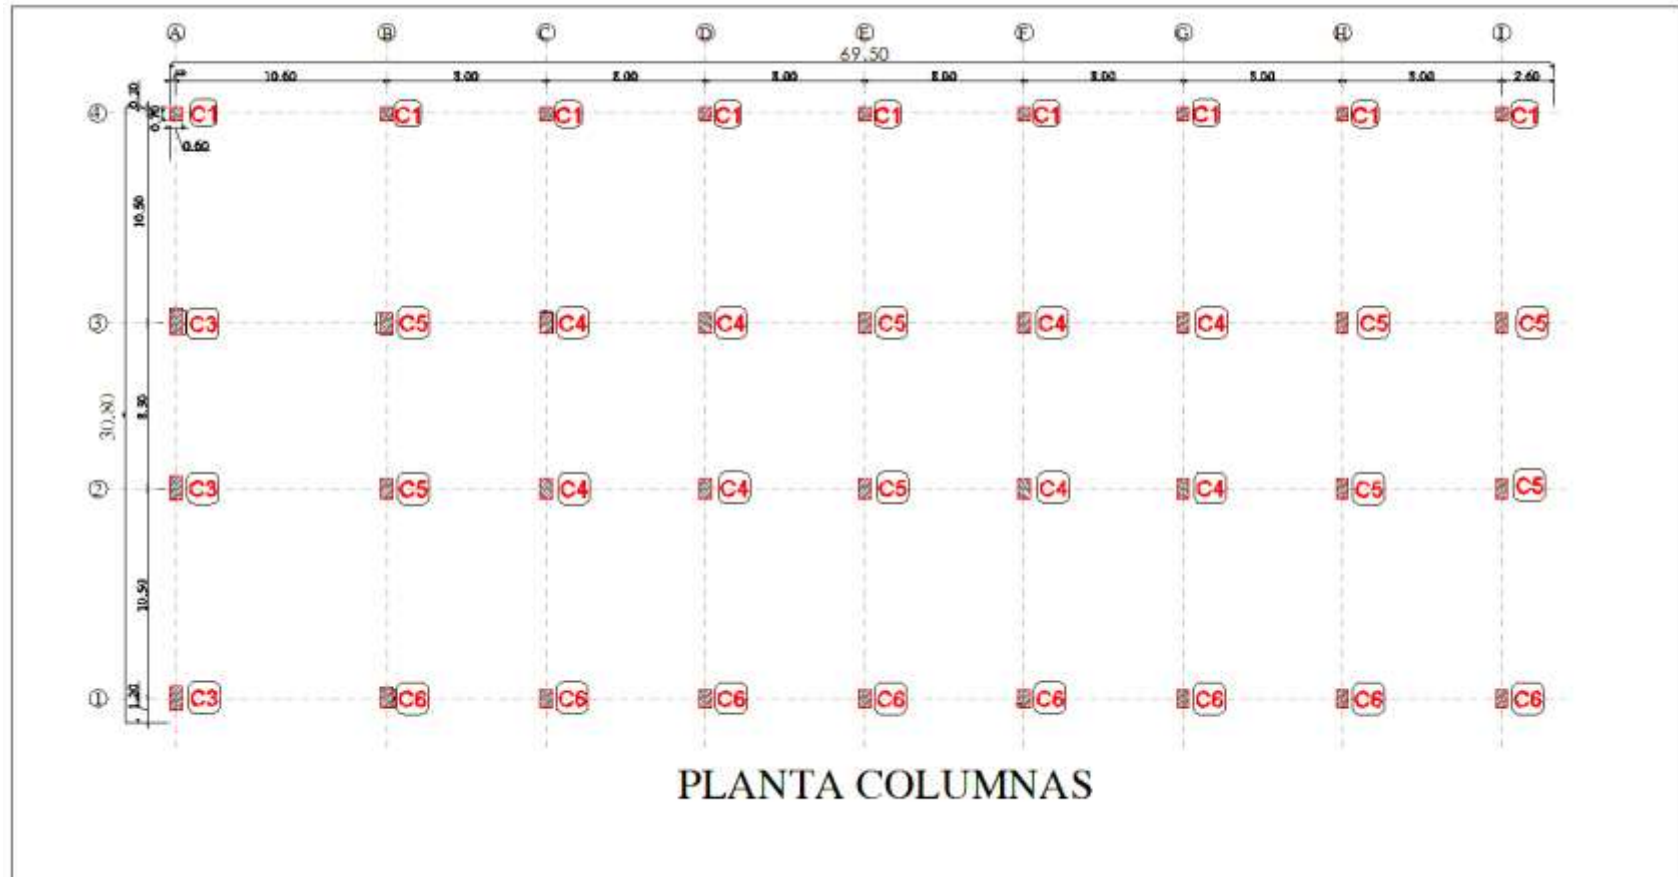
Planta columnas para edificio 10-12 y 15 niveles
